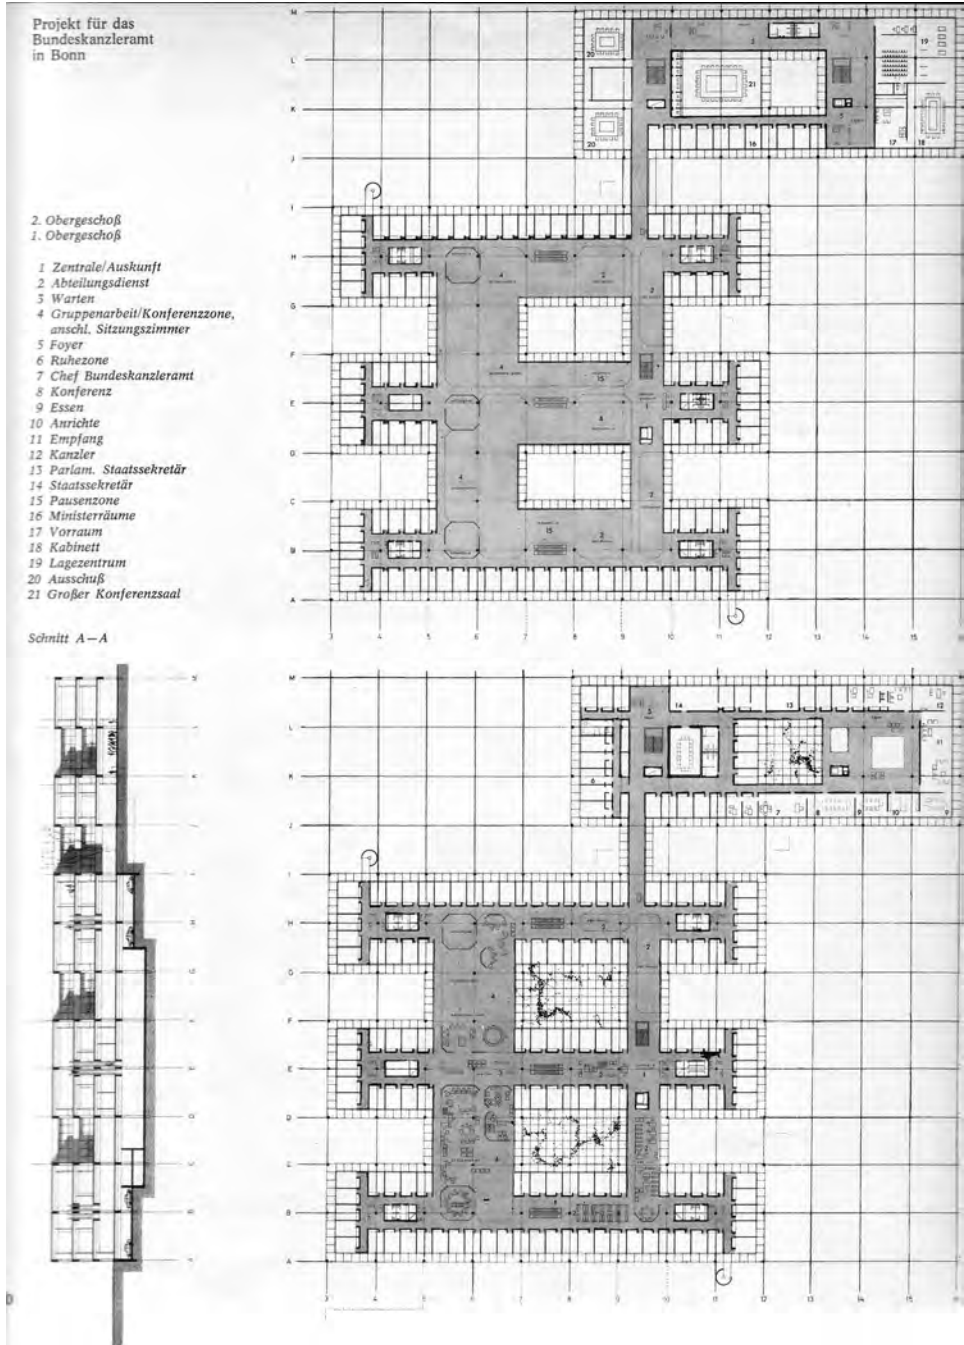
Planungsgruppe Stieldorf: Entwurf Kanzleramtsneubau. Grundrisse erstes und zweites Obergeschoss.
